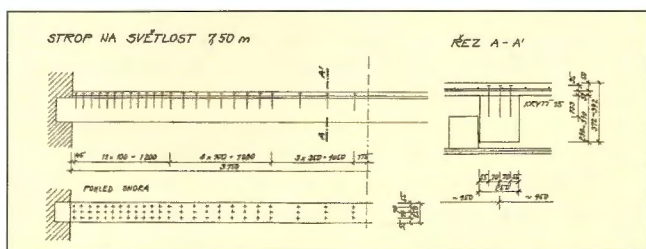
Pohled na nýtovaný nosník před rekonstrukcí / Rivet beam view, before reconstruction
